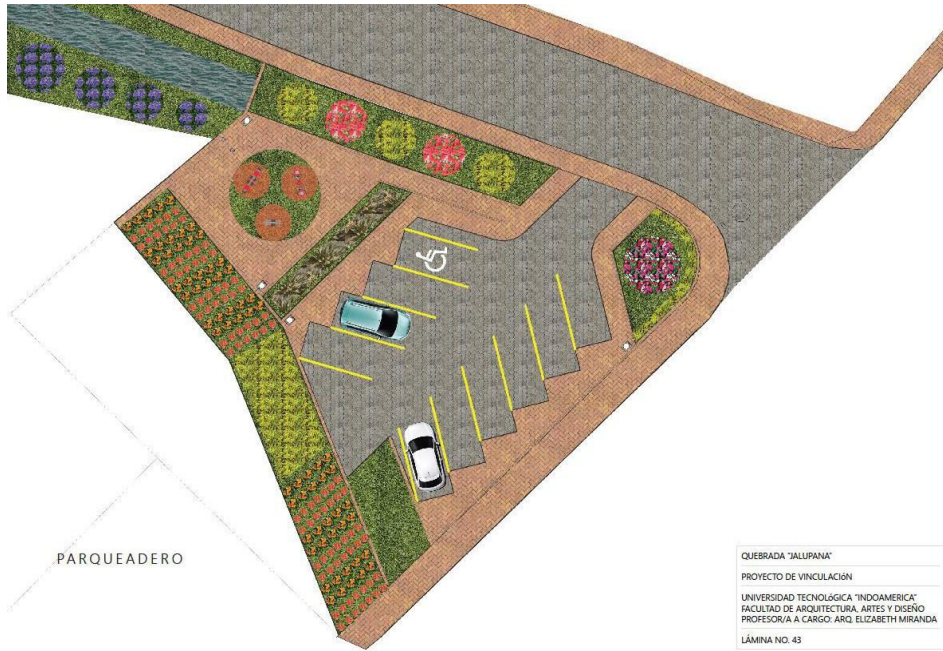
Planta parqueaderos. Fuente: Elaboración propia
